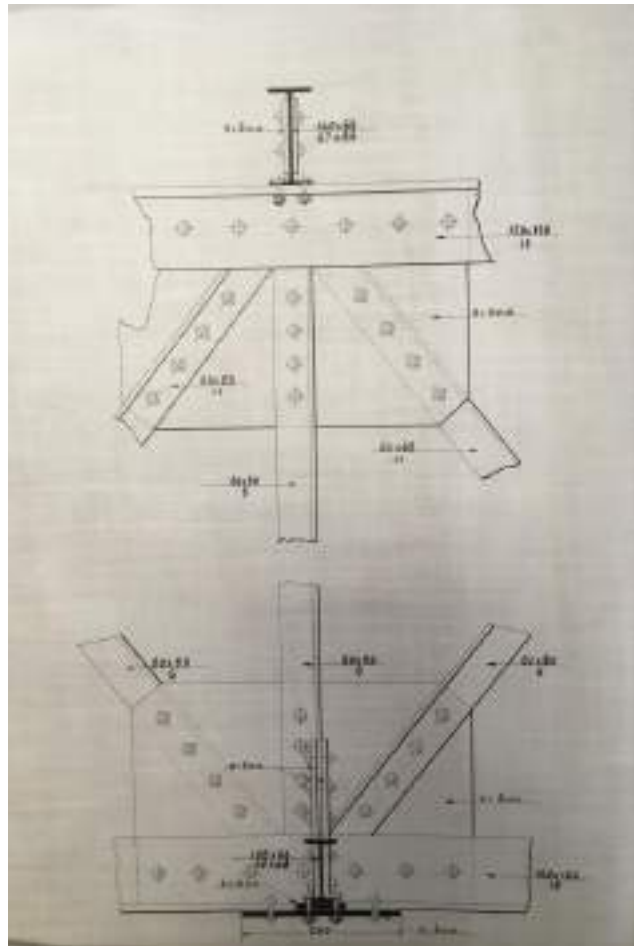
Detalles del entramado y roblonado de la estructura metálica para la cubierta del pabellón central, "Proyecto de entramado metálico para la cubierta del Pabellón Central del Edificio de Viajeros", 1907. AHF-MFM. signatura B57-6 6/16.
